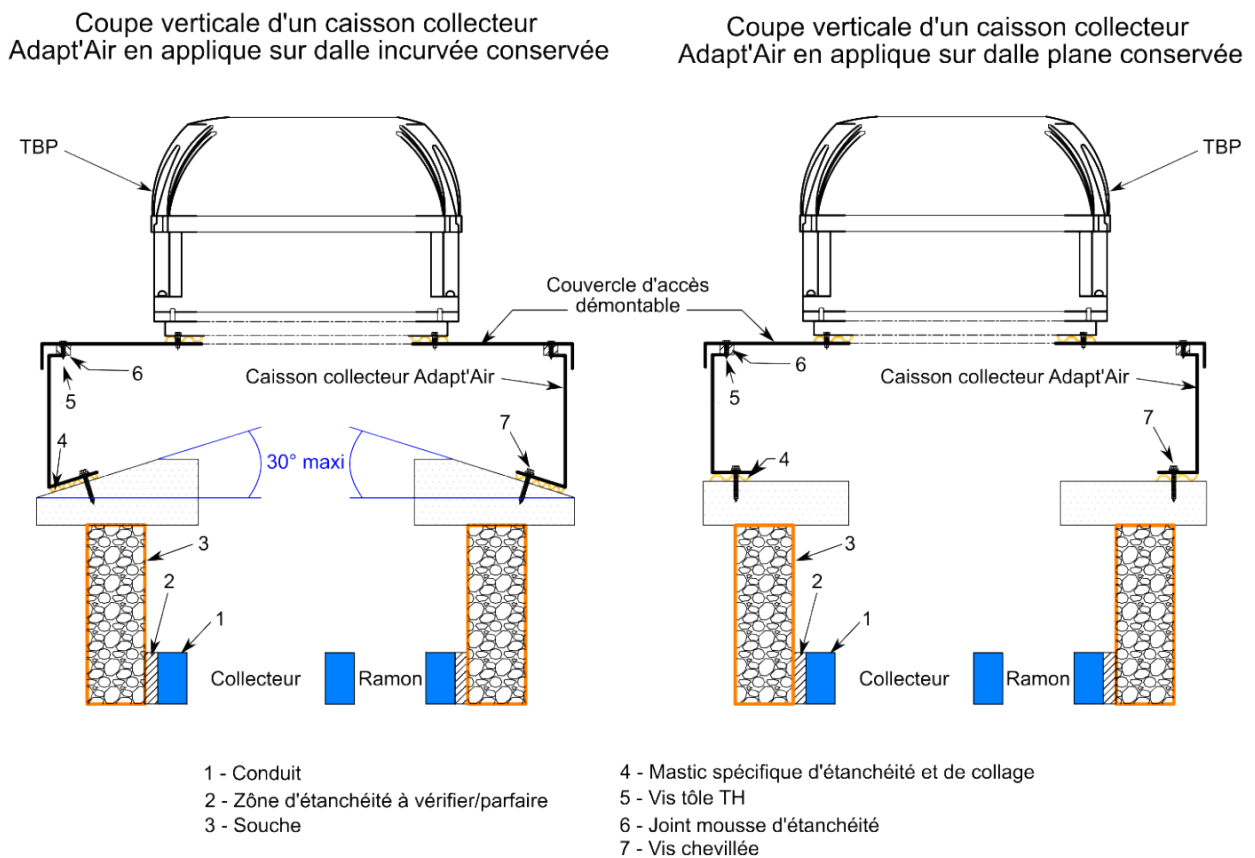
Coupe verticale d'un caisson collecteur Adapt'Air en applique (sans goutte d'eau) sur dalle existante
